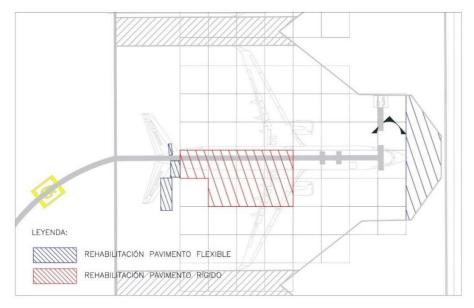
Sectores del pavimento a reparar en el PEA – 65. Fuente: Información del proyecto
